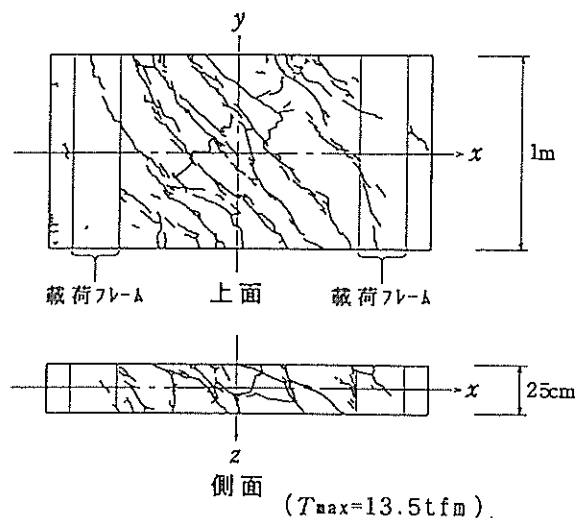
供試体 RC-19-200のひび割れ発生位置
